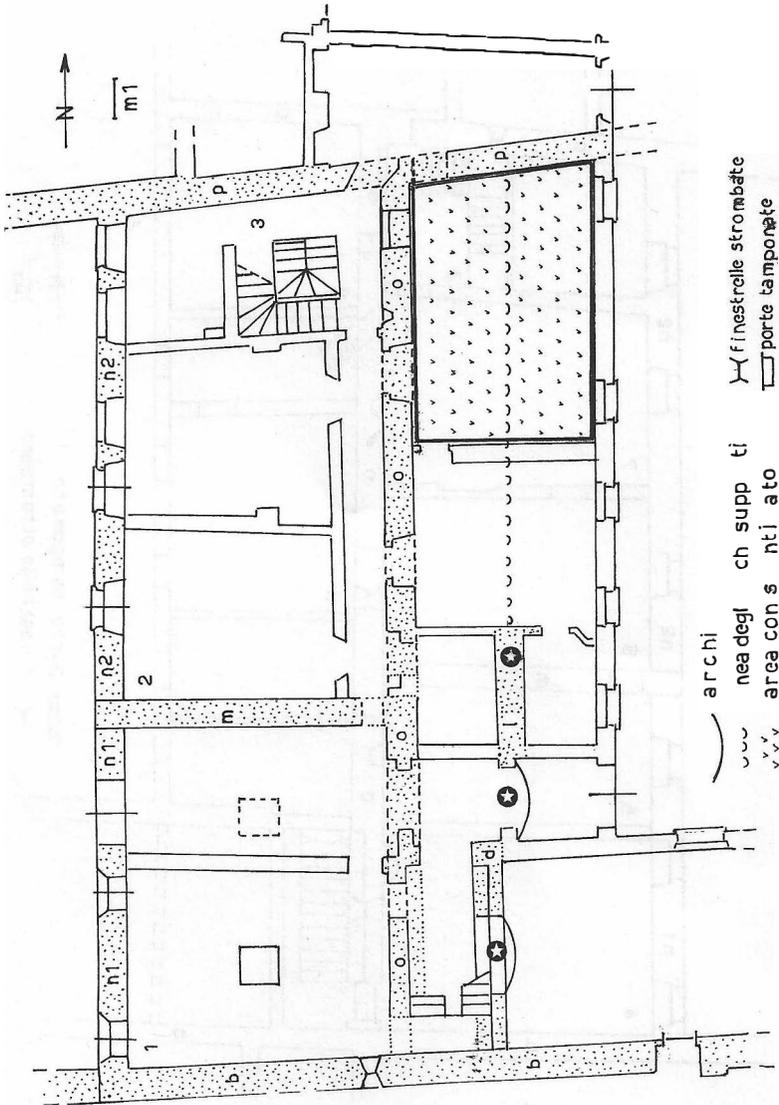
Piazza Canonica di San Pietro, nn 12-14, planimetria del pianterreno.
